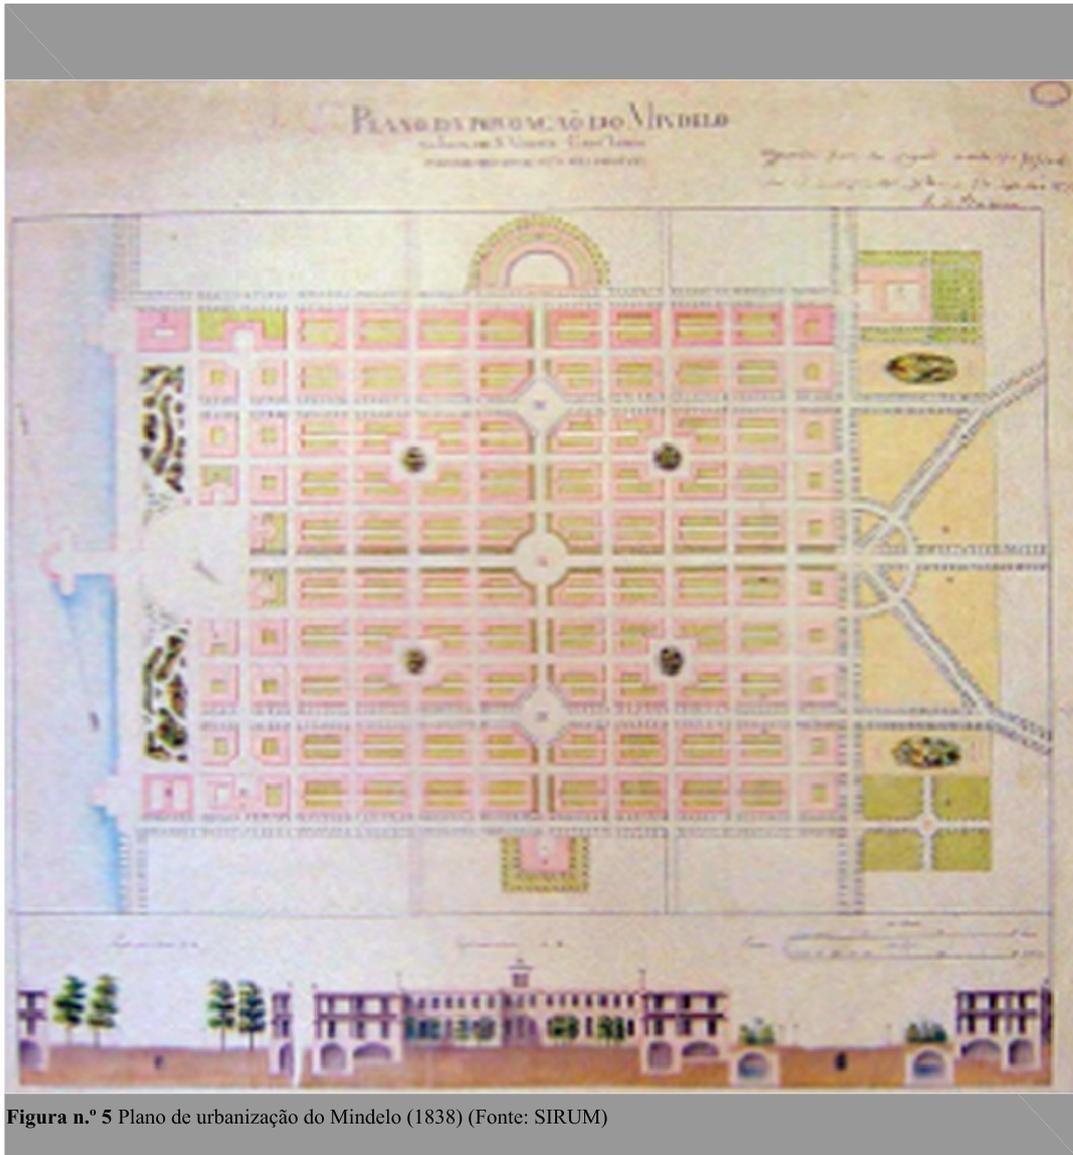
Plano de urbanização do Mindelo (1838) (Fonte: SIRUM)
